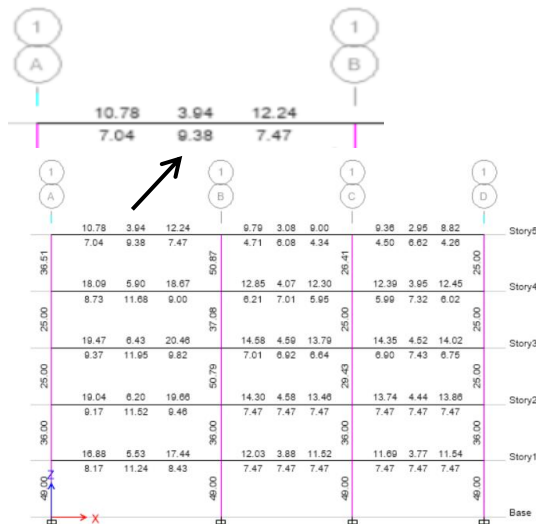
ETABS Área de acero de refuerzo en columnas del edificio de hormigón tradicional
